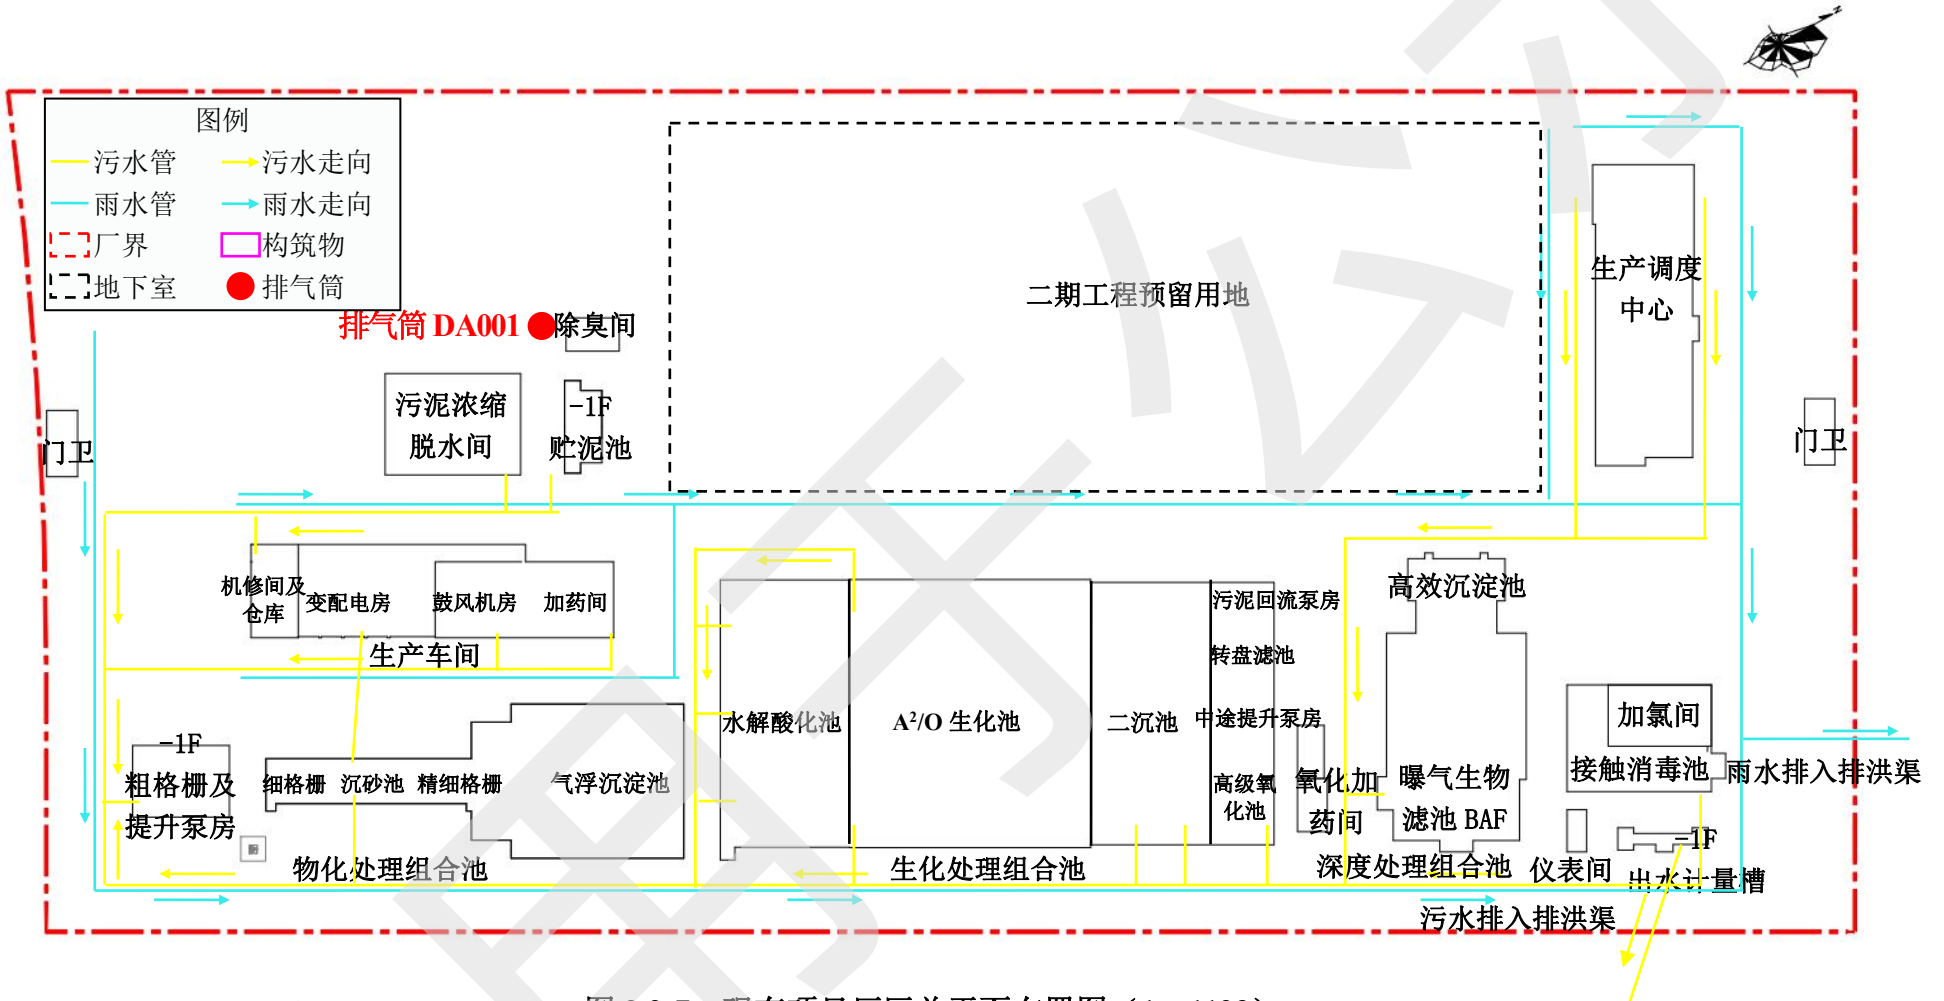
现有项目厂区总平面布置图 (1: 1123)
